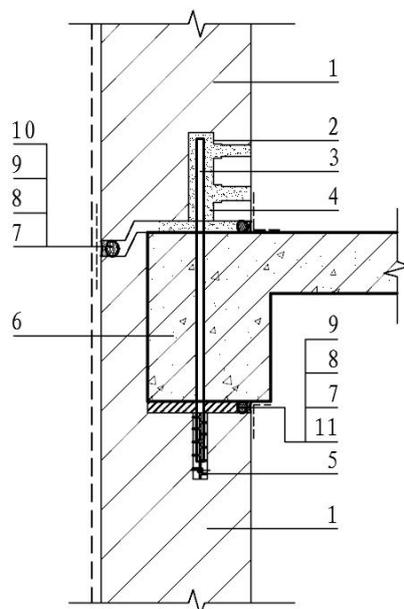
轻混凝土外墙板与主体结构钢筋灌浆连接构造示意图
